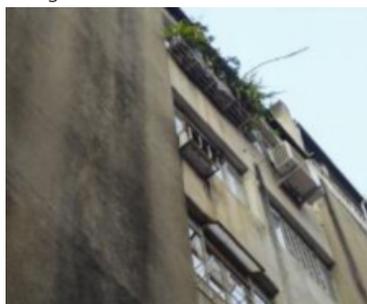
Detalle fachada sur, C 4: cableado de TV, sin canalización
